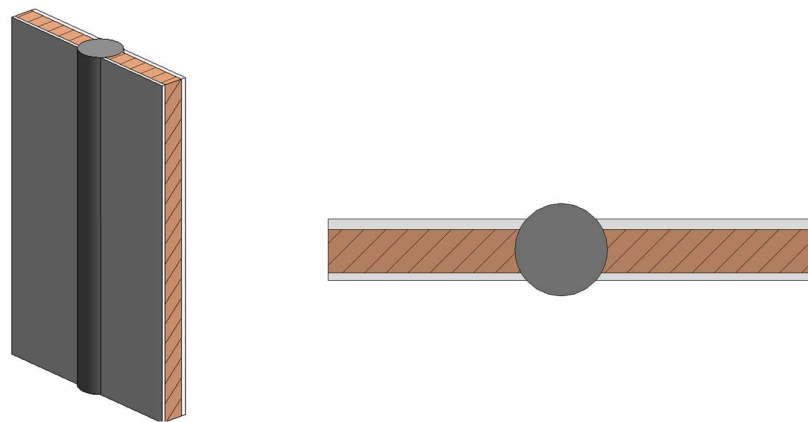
Vista en 3D y en planta del Muro 2.
